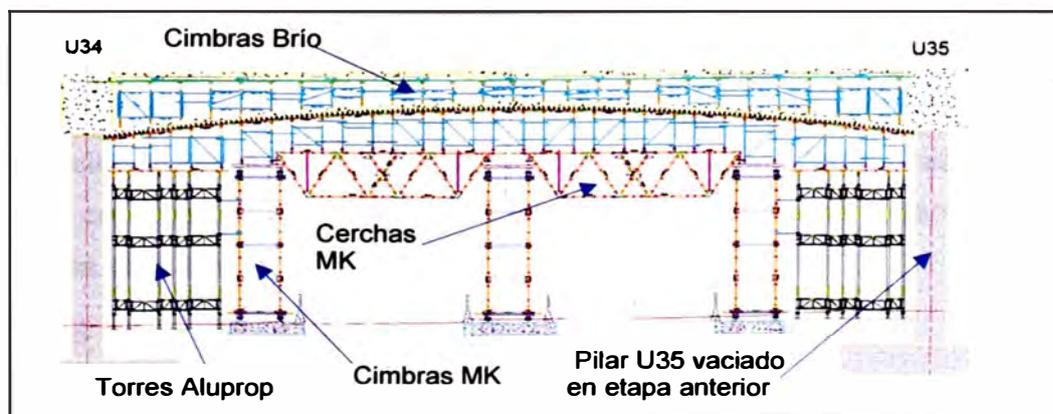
Vista general del encofrado del puente Santa Rosa.
